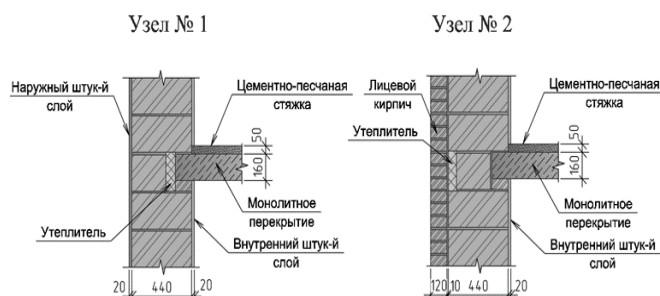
Конструктивные решения узлов опирания монолитного перекрытия на наружные ограждающие конструкции
